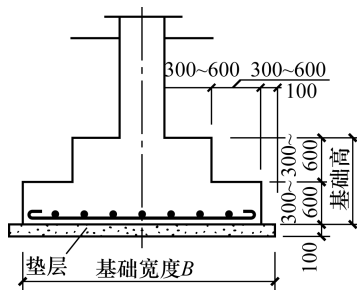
阶梯形钢筋混凝土基础(单位: mm)
